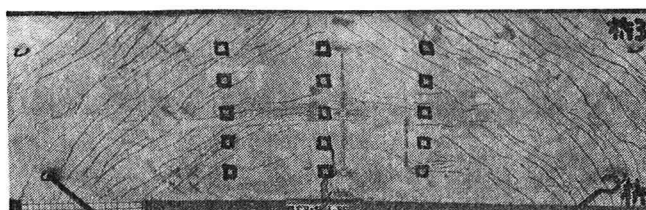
中間横桁のあるモデル橋MT4の破壊後の床版のひびわれ
